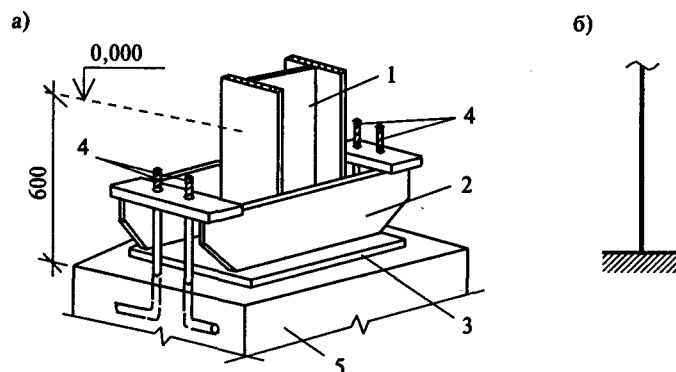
Жесткое крепление колонны к фундаменту: а) конструктивная схема; б) расчетная схема; 1 — колонна; 2 — траверса; 3 — опорная плита базы колонны; 4 — анкерные болты (гайки, шайбы не показаны); 5 — фундамент
